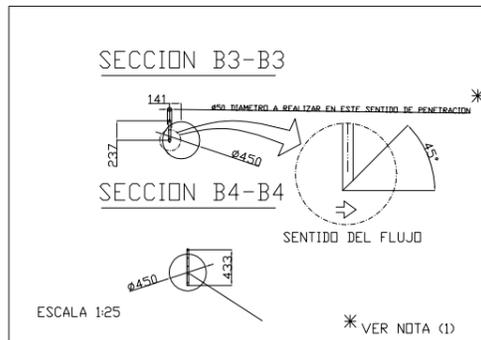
PLANO DE DISPOSICIÓN ALZADOS - RMTA
